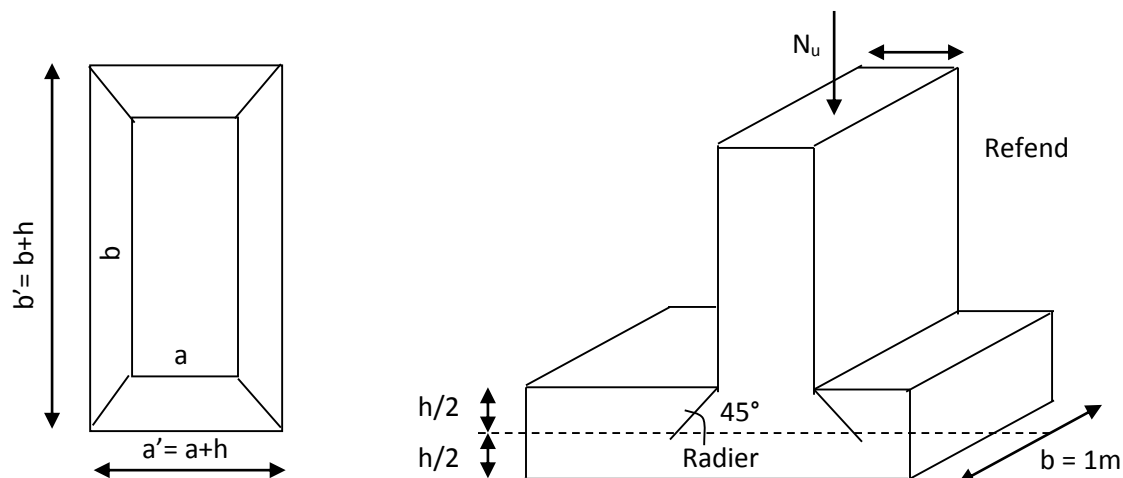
Périmètre utile des voiles et des poteaux.
